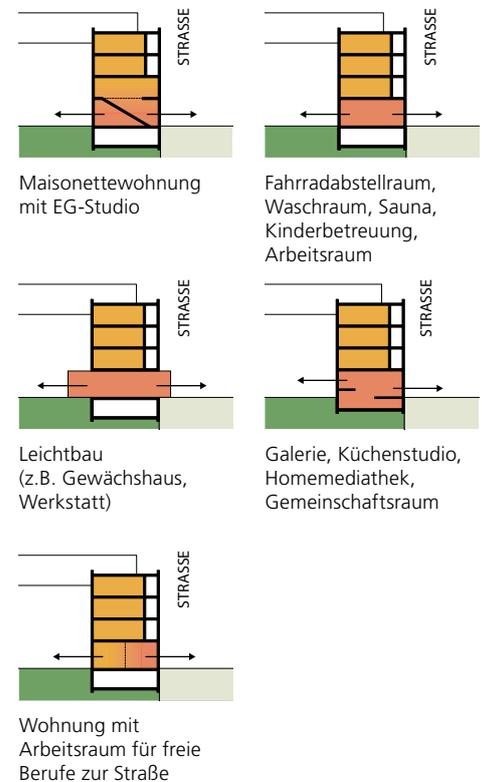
Schema: Flexible Erdgeschossstruktur zur Römerstraße (Westseite) mit beispielhaften Nutzungen
